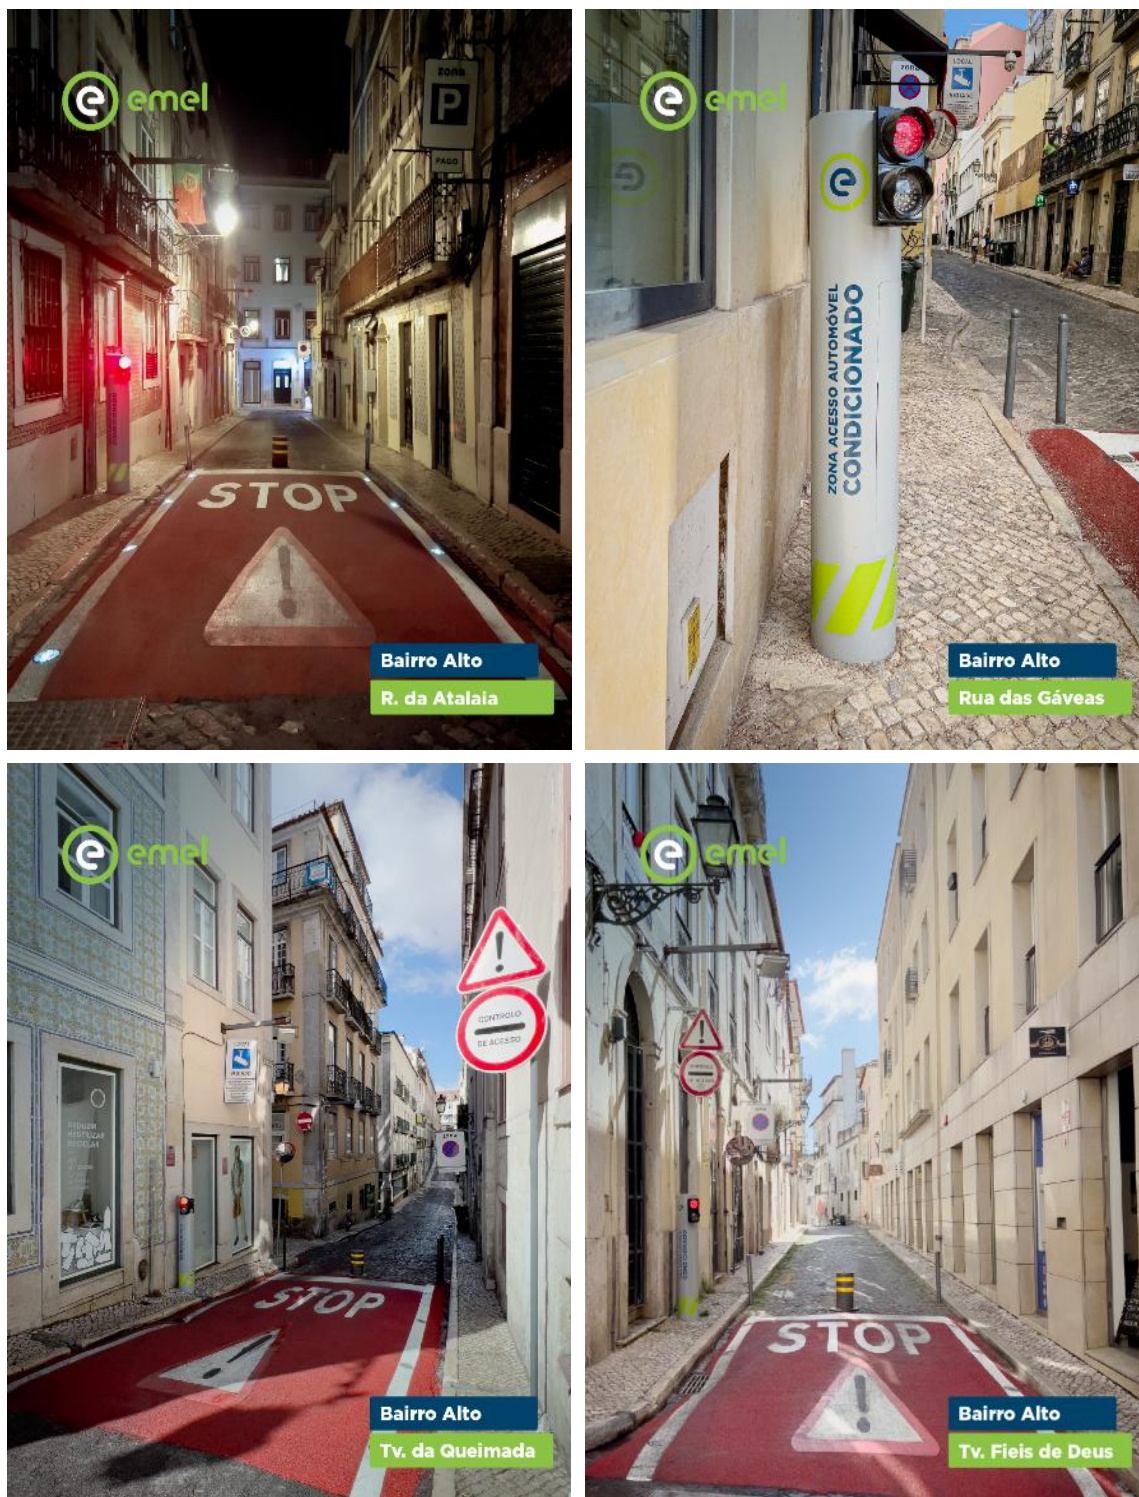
Repavimentação, repintura e renovação de Sinalização ZAAC Bairro Alto
